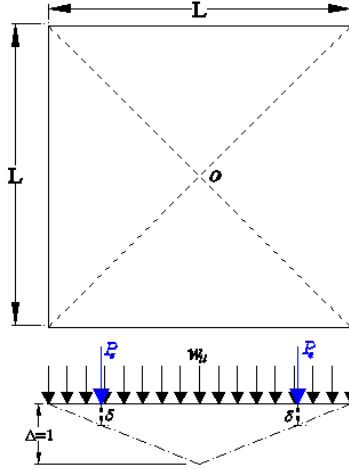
Configuración deformada de una losa cuadrada en dos direcciones con carga uniformemente distribuida, de la cual se calcula el trabajo externo
